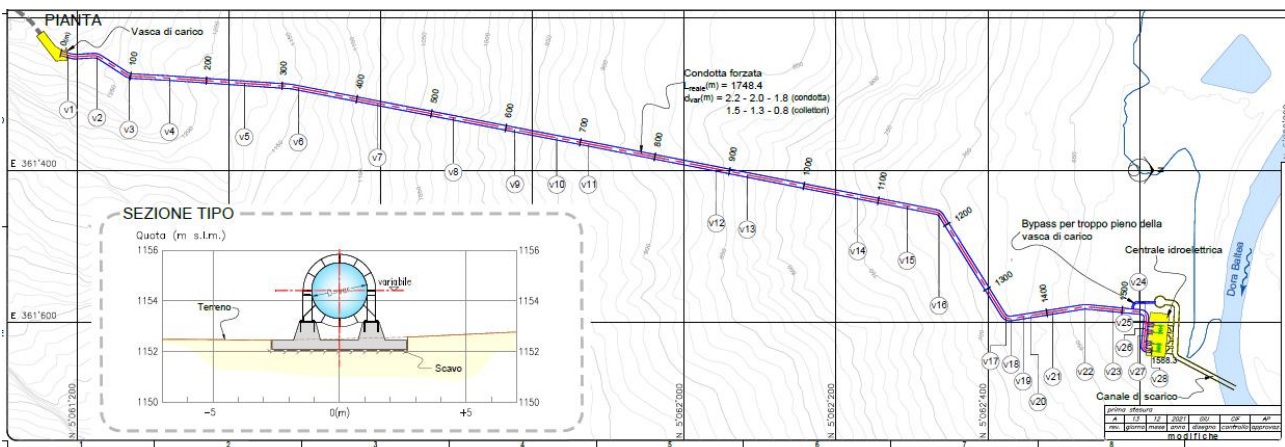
Tracciato planimetrico della condotta forzata di Chavonne
